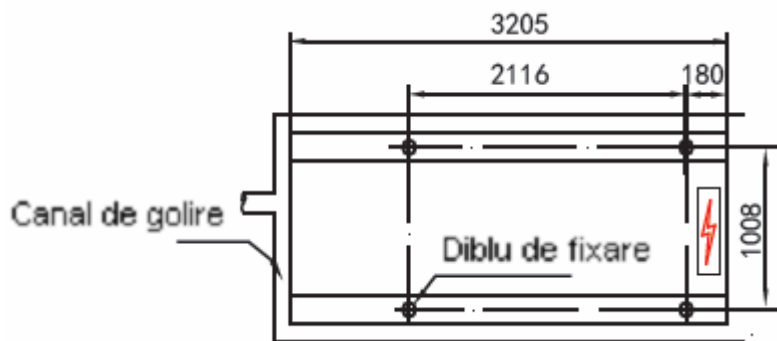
Schema dimensiunilor de instalare MC-SU90M/RN1L
